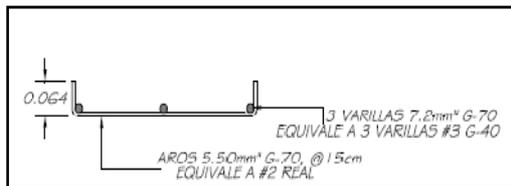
Detalle de la armadura de cimentación para vivienda modulada de un nivel. Fuente: Manual para la construcción de edificaciones mediante el uso del sistema Modublock.
